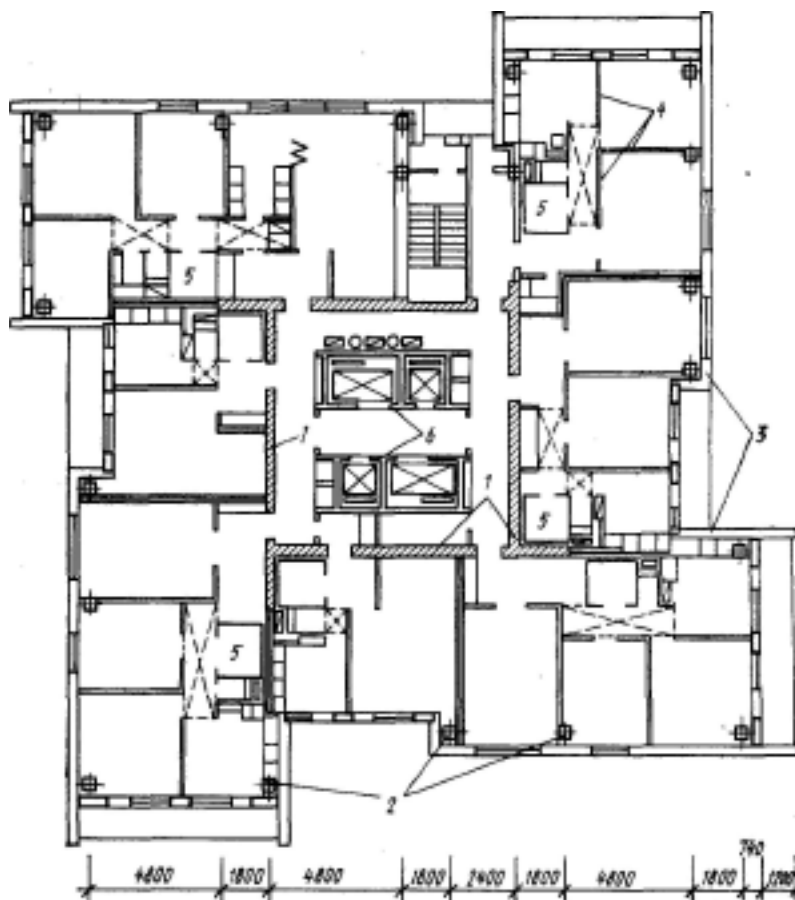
Каркасно-панельный 25-этажный жилой дом с монолитным ядром жесткости: План типового этажа:
